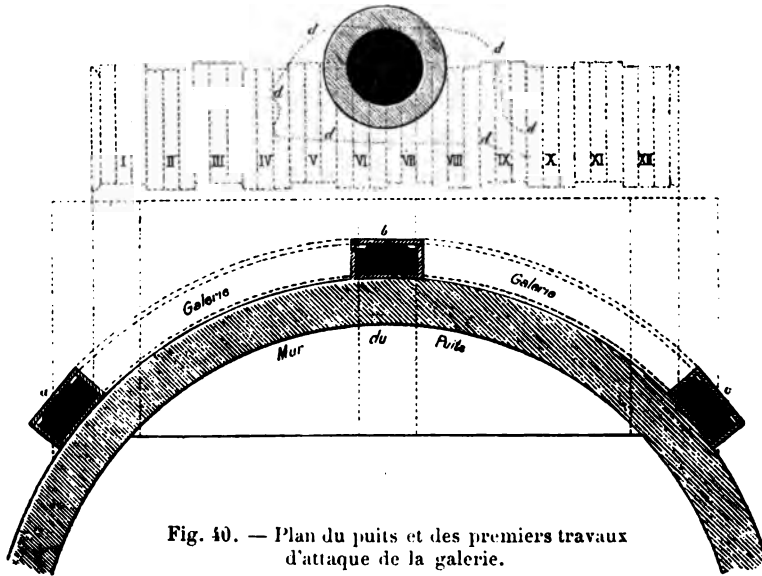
Plan du puits et des premiers travaux d'attaque de la galerie.
